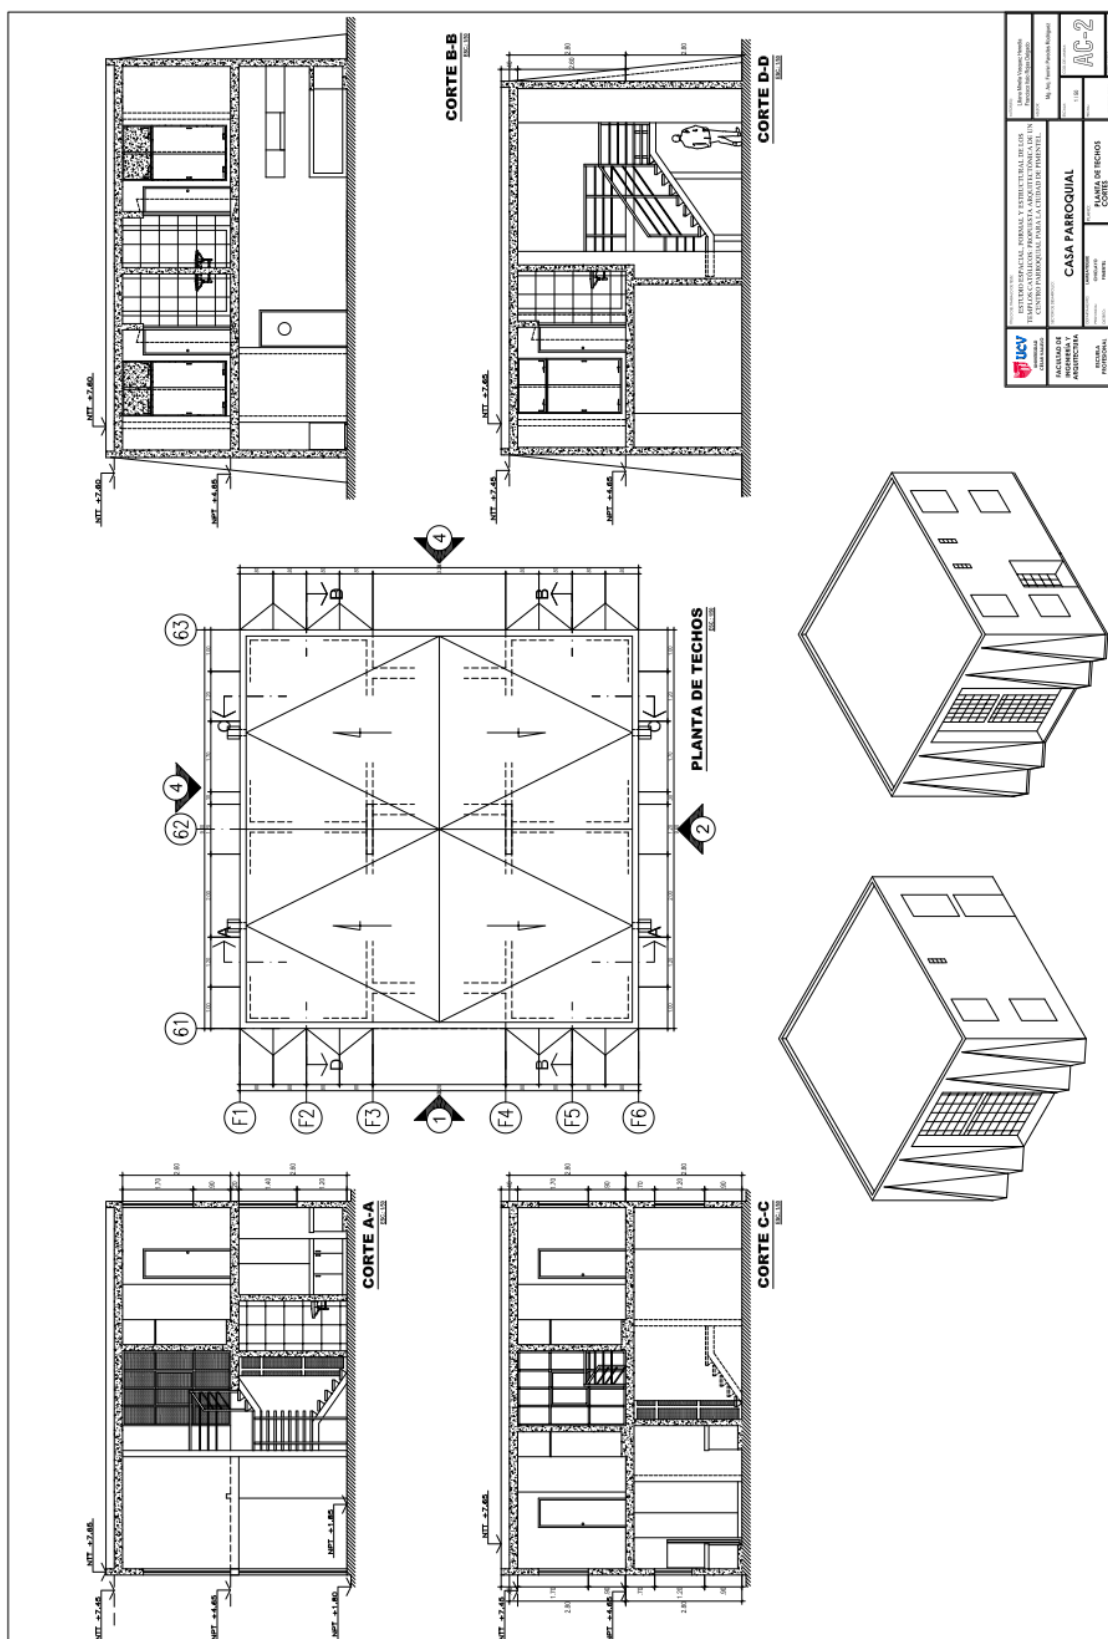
Planos –planta, cortes, elevaciones – CASA PARROQUIAL
